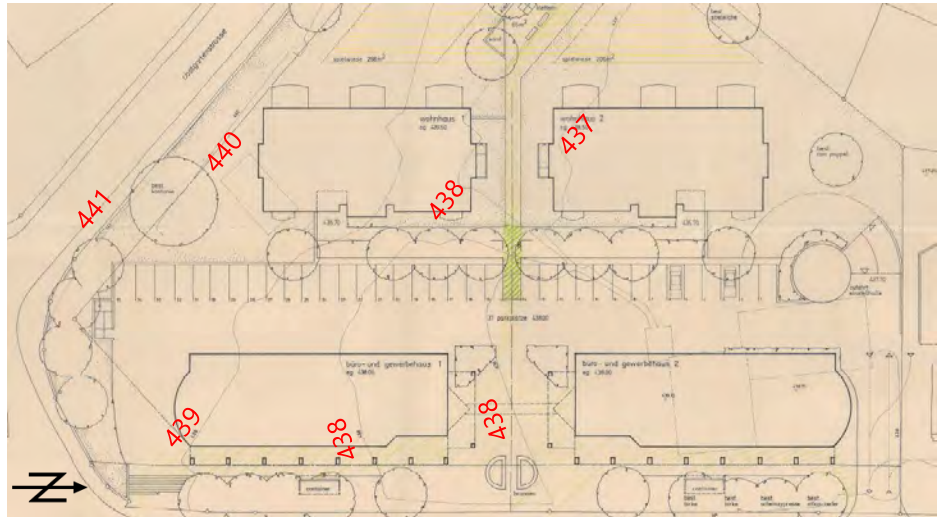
Umgebungsplan bestehende Bebauung, dat. 01.11.1988
